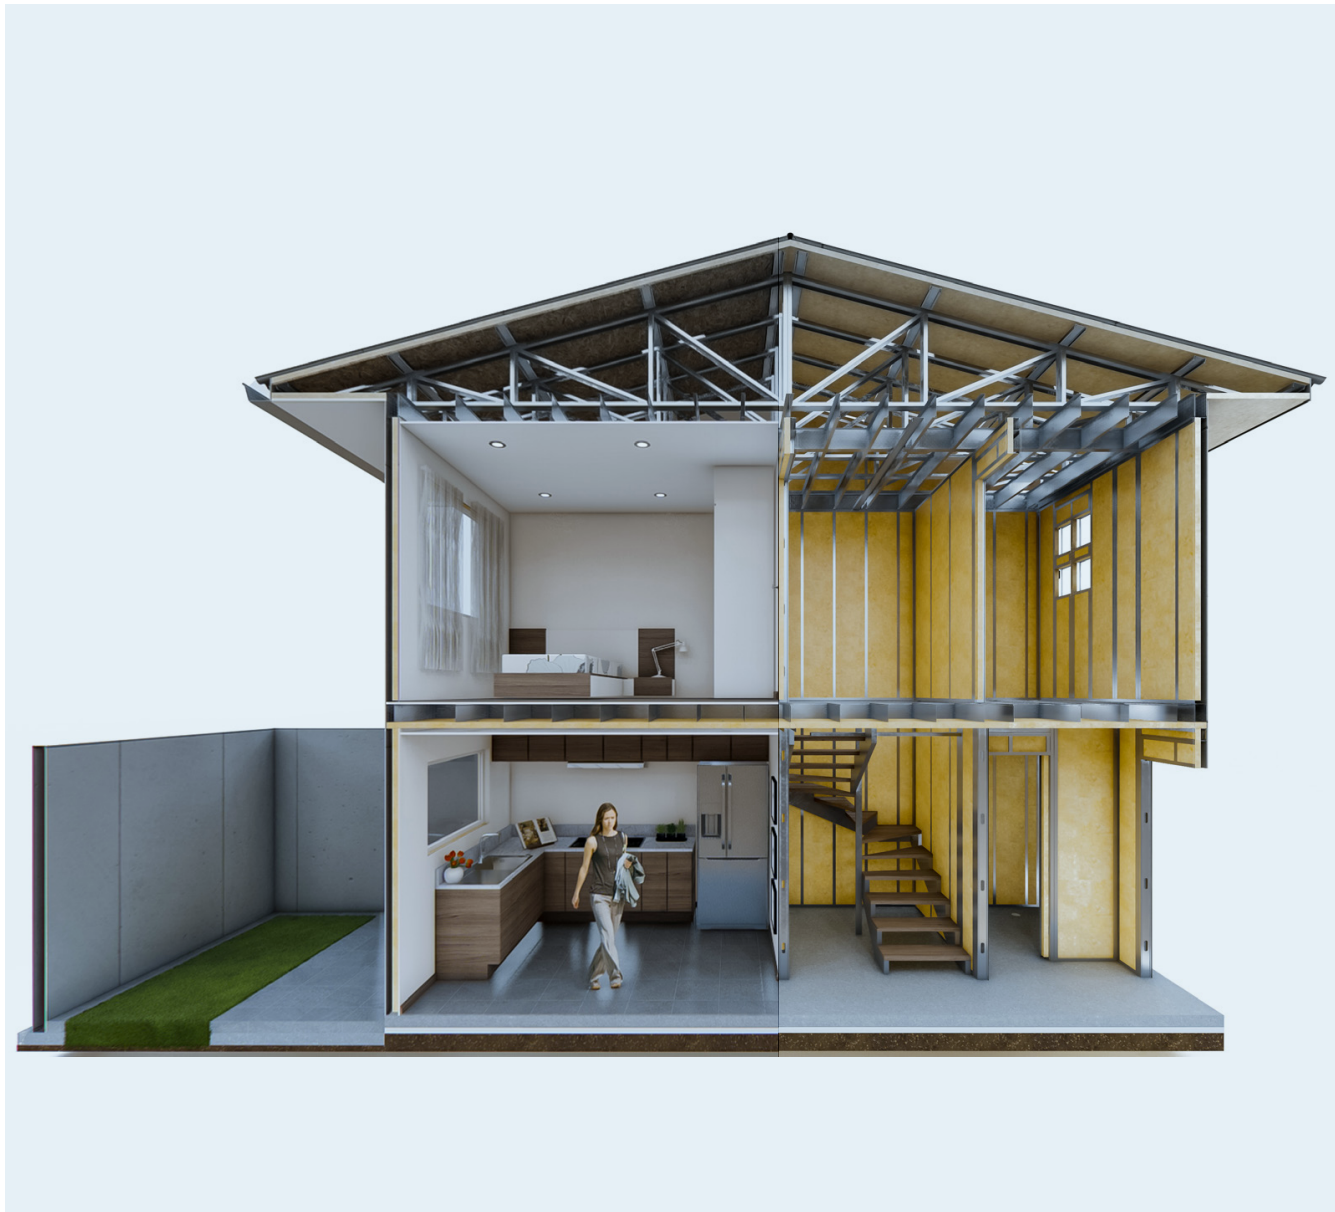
Propuesta de la vivienda unifamiliar de dos plantas con el sistema constructivo LSF
